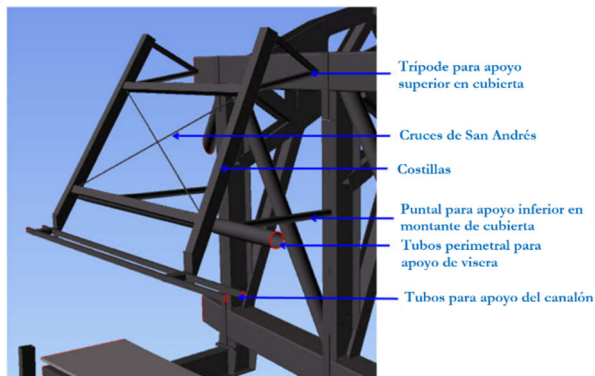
Configuración de módulo de visera en fondos Norte y Sur
